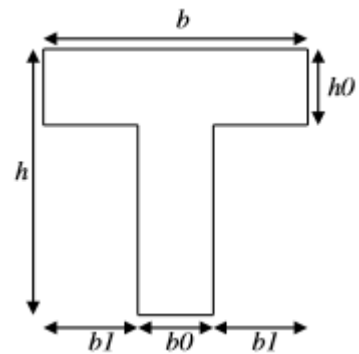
Dimension d'une poutrelle (CBA93 Article 4.1.3)
